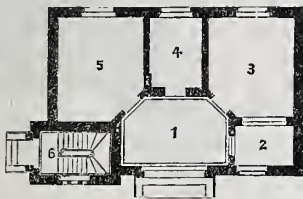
Grundriss vom Erdgeschoss.
